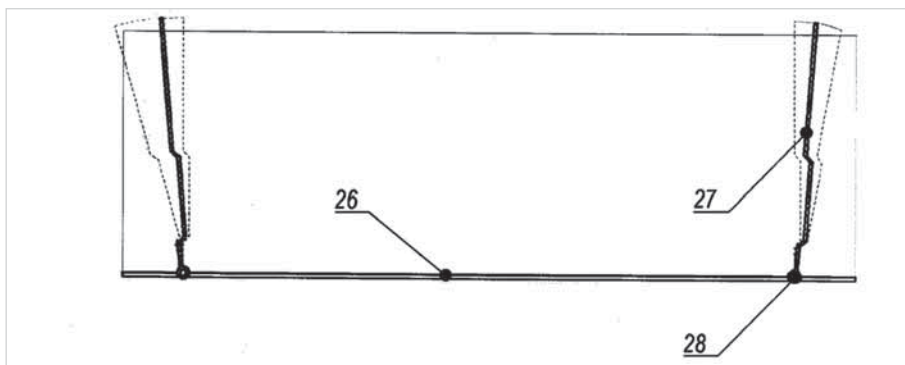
Схема универсальной опалубки для изготовления блоков арки (кроме крайних блоков)
